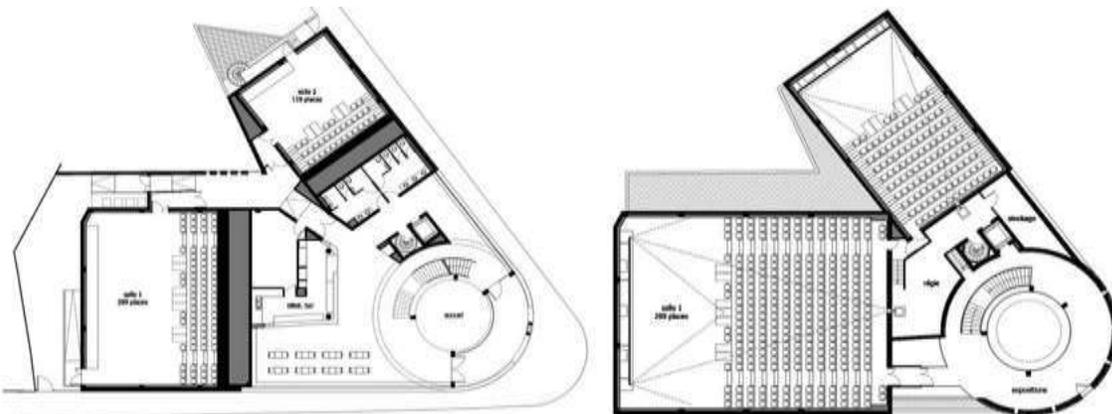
Plantas arquitectónicas del Cine Zoetrope, (octubre 2018), Recuperado de : <https://www.archdaily.mx/mx/762385/cine-zoetrope-adh>.
